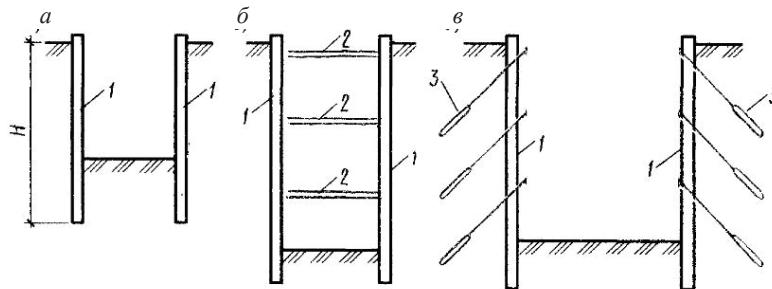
Конструктивные схемы сооружений с параллельными стенами: *a* – консольная стена; *б* – стены с креплением распорками; *в* – стены с креплением анкерами. 1 – стена; 2 – распор; 3 – анкер; *H* – глубина заложения стены
